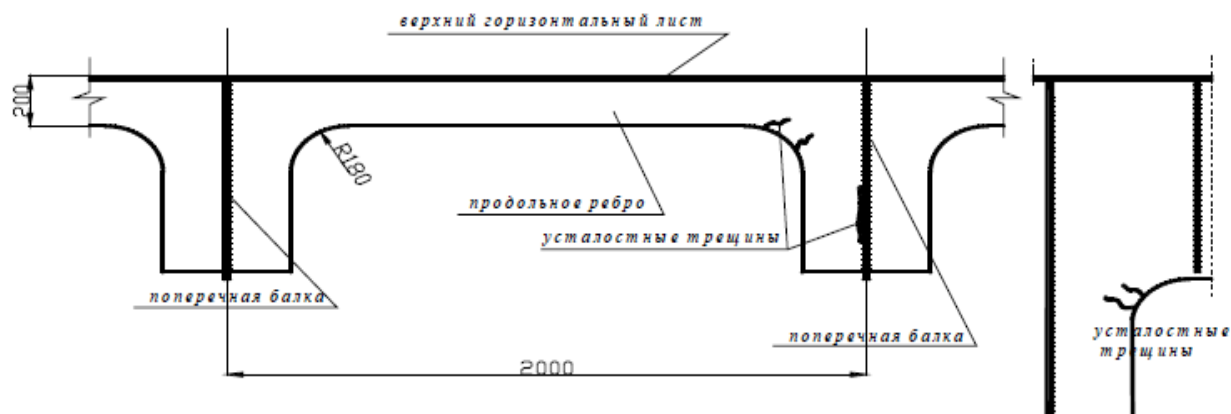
Усталостные трещины в элементах одноярусной ортотропной плиты с продольными ребрами, не пересекающими поперечные балки
